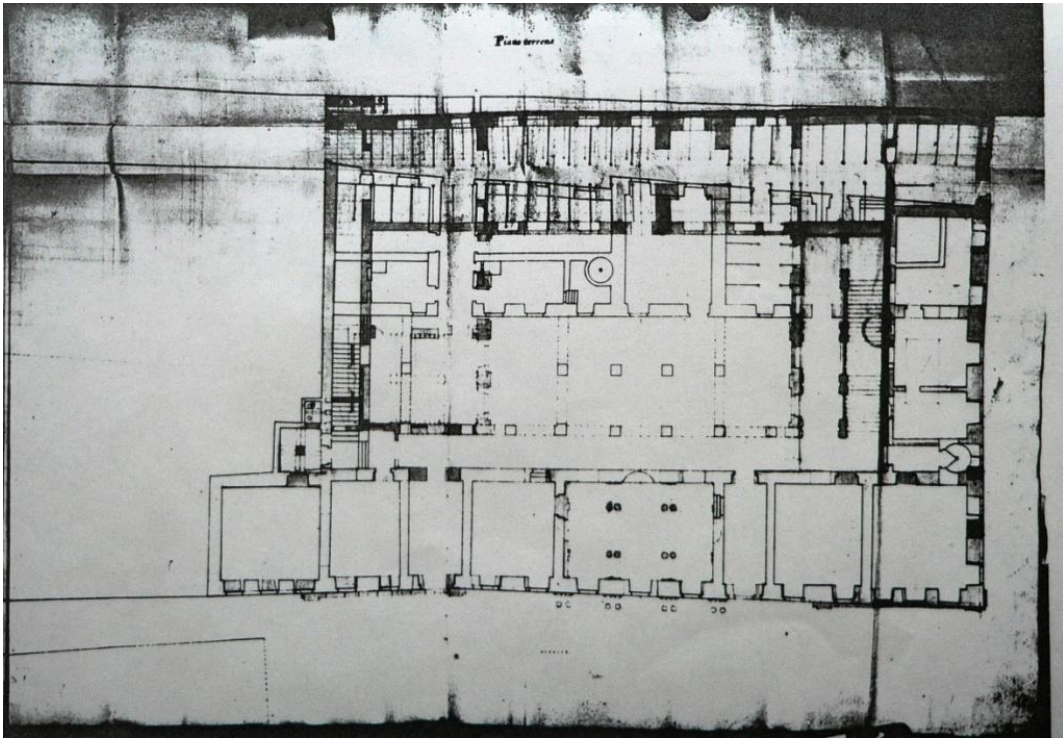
Das ehemalige Stadtpalais Schwarzenberg, Grundriss Erdgeschoss Martinelli 1694 (hell Realbestand, dunkel Neubauplanung).
